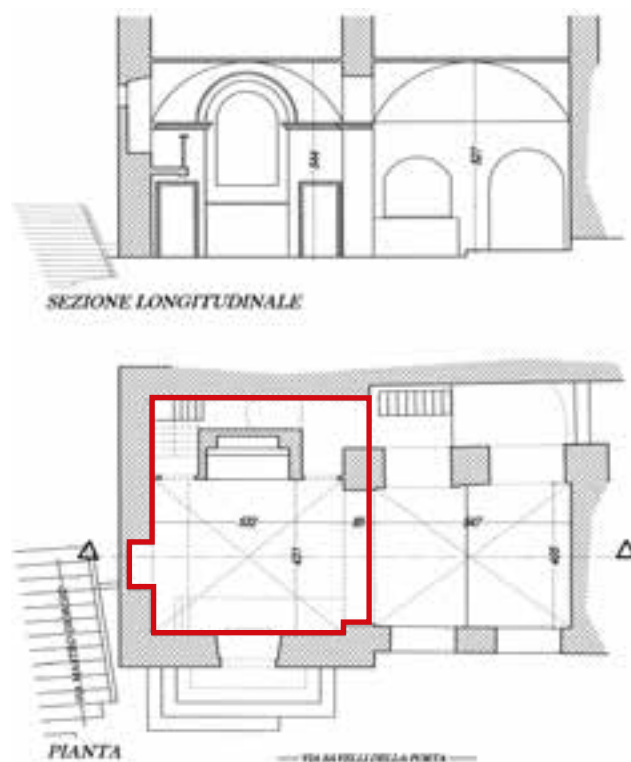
Sezione e pianta della chiesa dei Muratori. La linea rossa evidenzia la pianta originaria. Disegno di Alessio Alunno, marzo 2015
